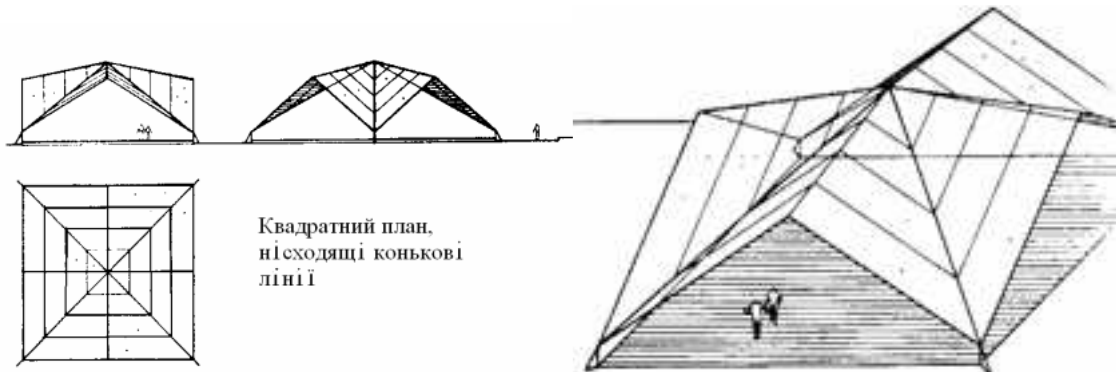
Шатрове покриття: план, фасади, загальний вид
